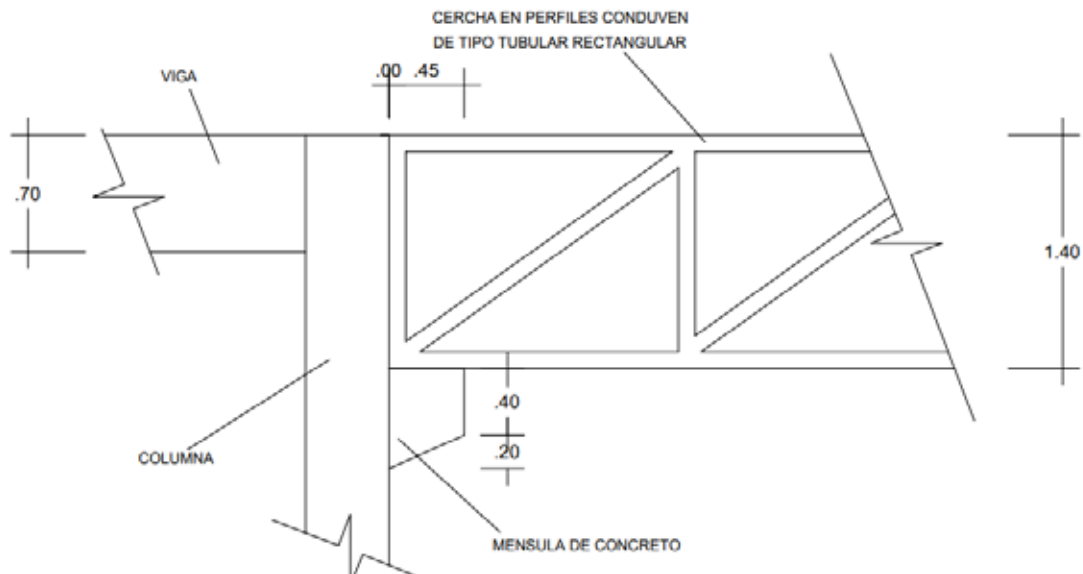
Detalle de Unión Cercha Columna. (2018)
